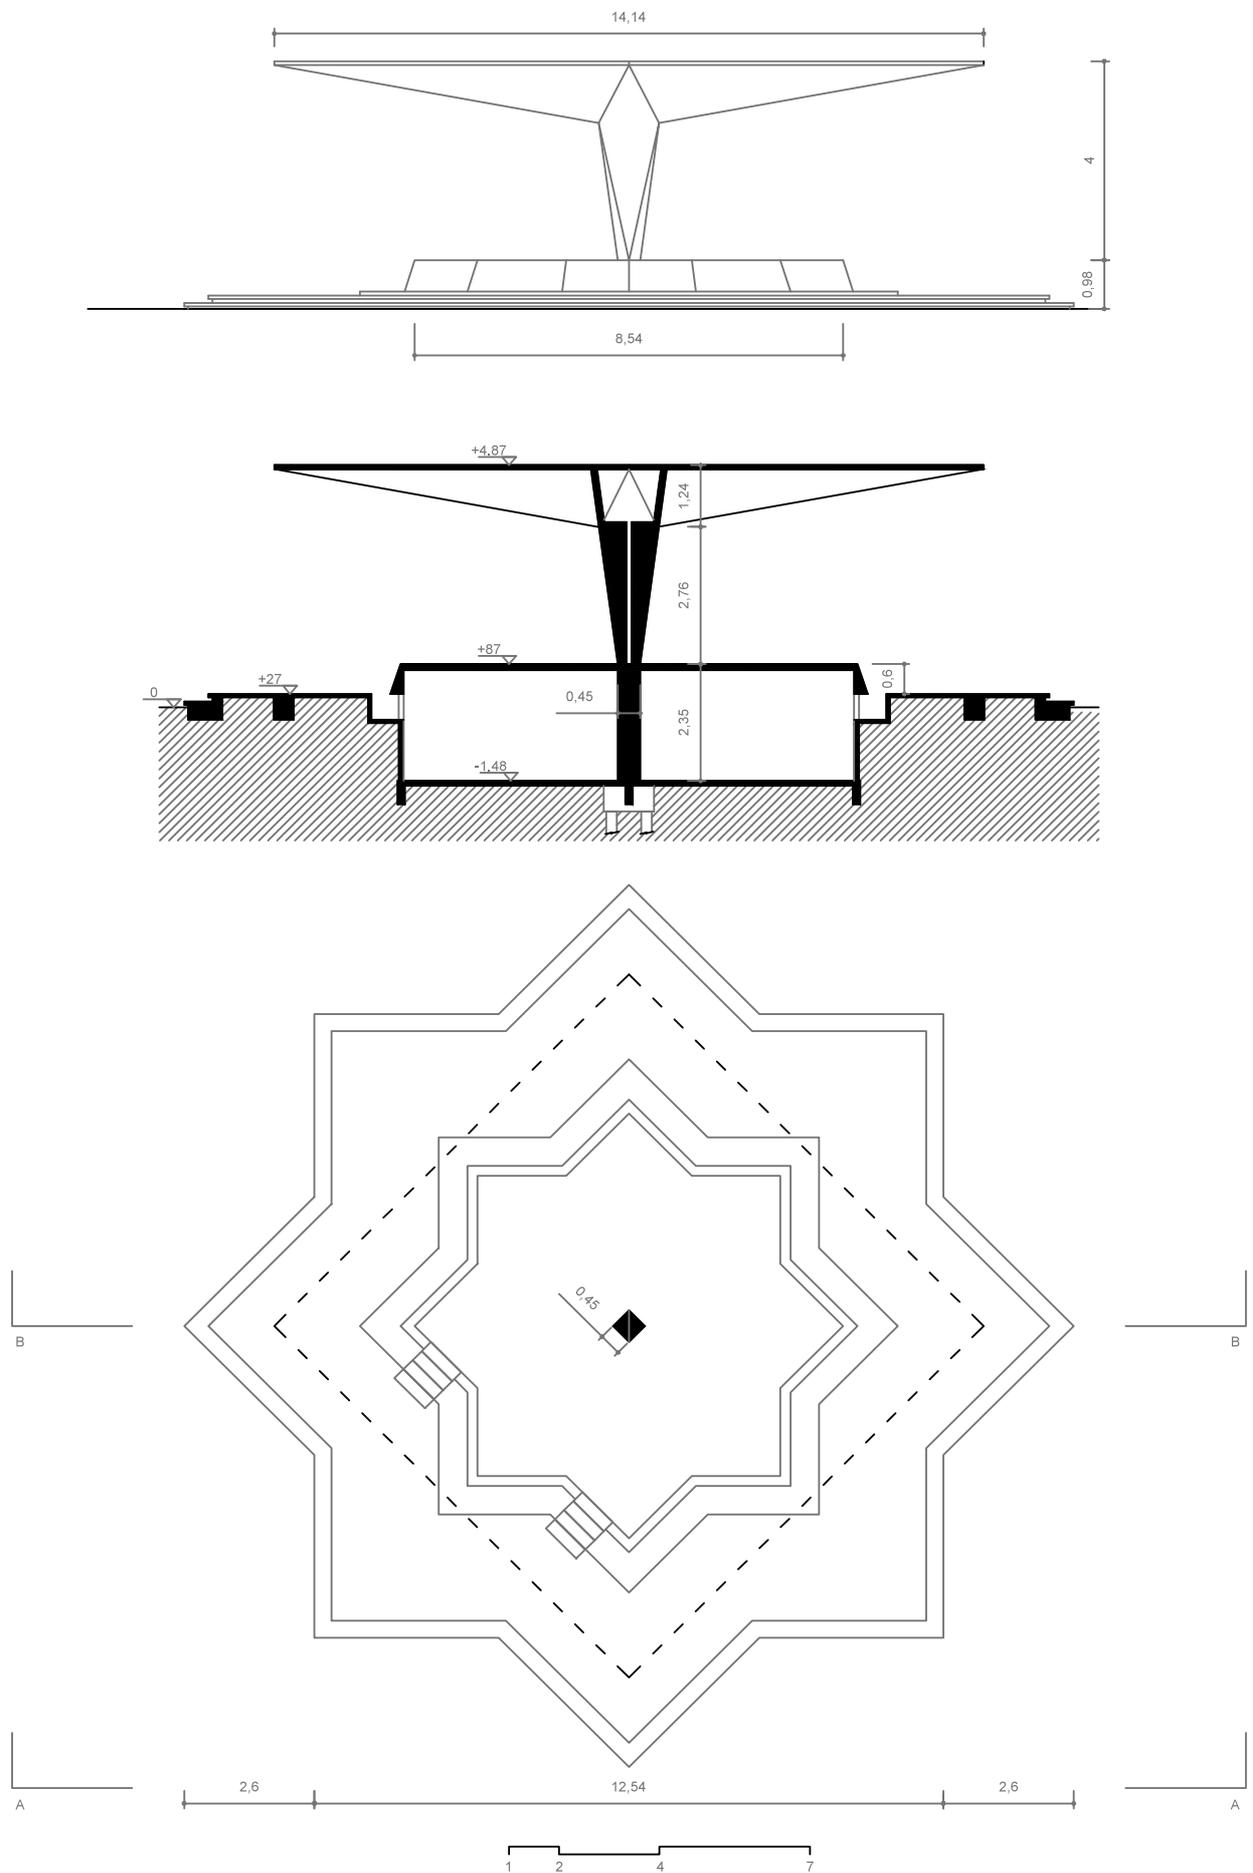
Planta, corte diagonal e elevação diagonal do Coreto.
